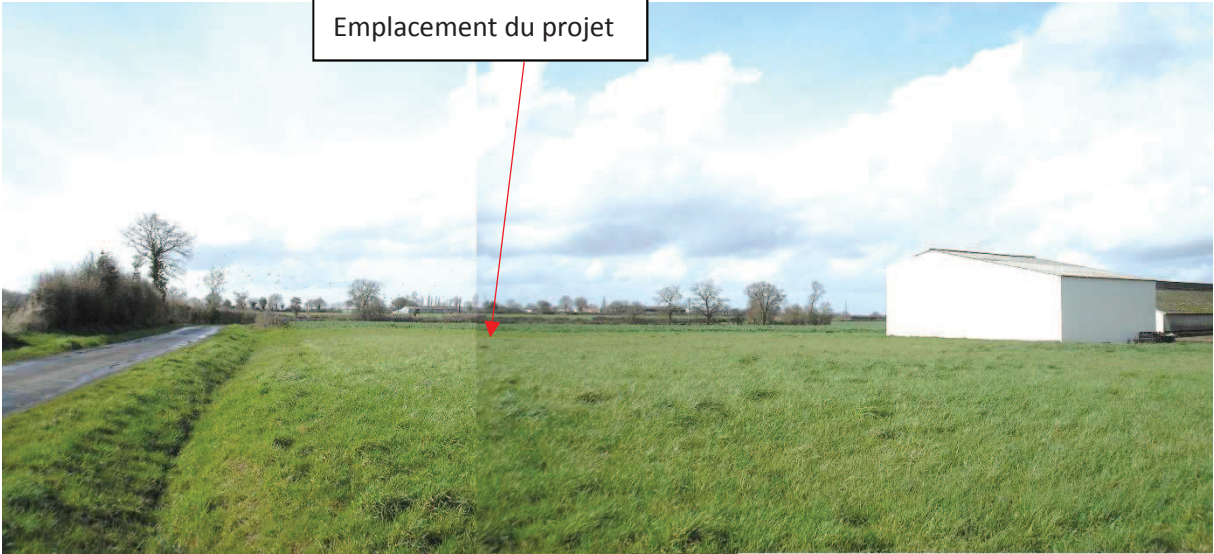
Vue sur le futur accès au bâtiment en projet, zone aménagée
